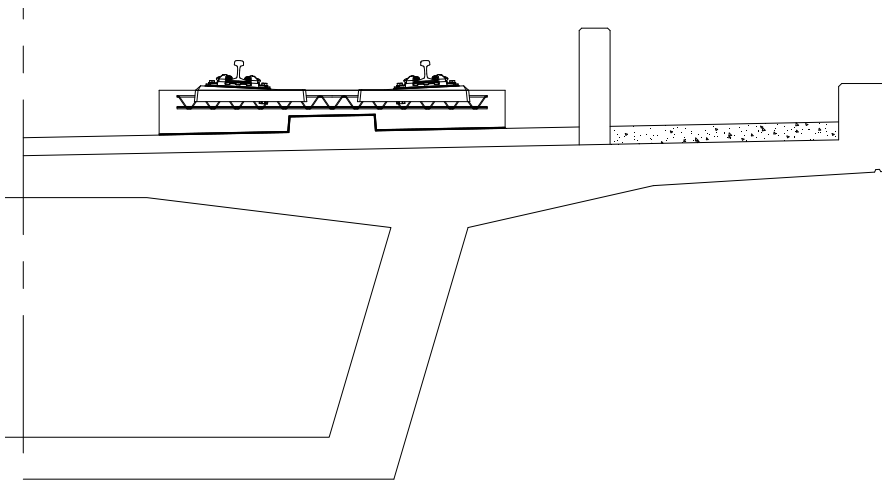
경부고속철도 2단계, 호남고속철도(Concrete Slab Track)
